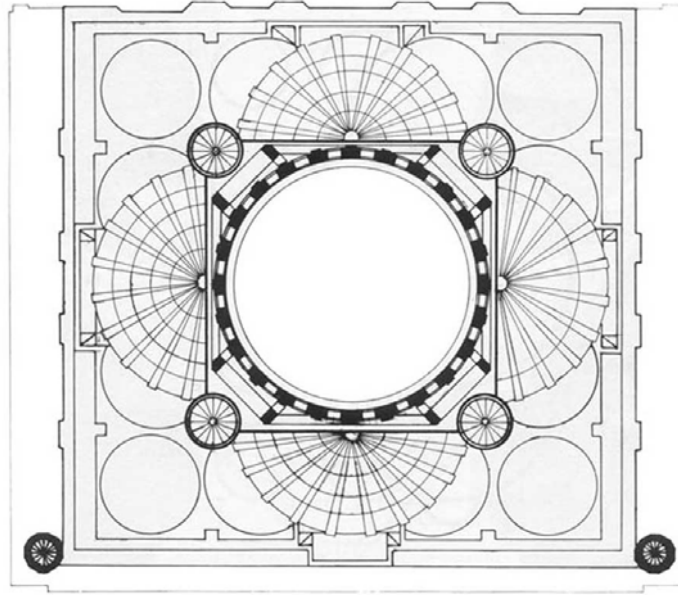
Şehzade camisi plan (URL-2, 2010)
